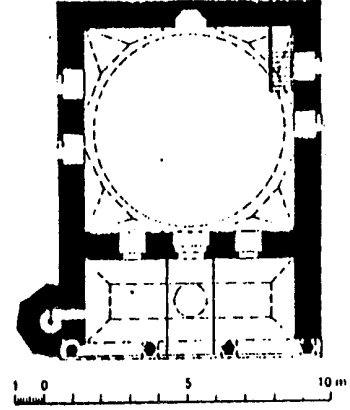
مسقط أفقي لمسجد طاش بقونية (عن : Aslanapa)
